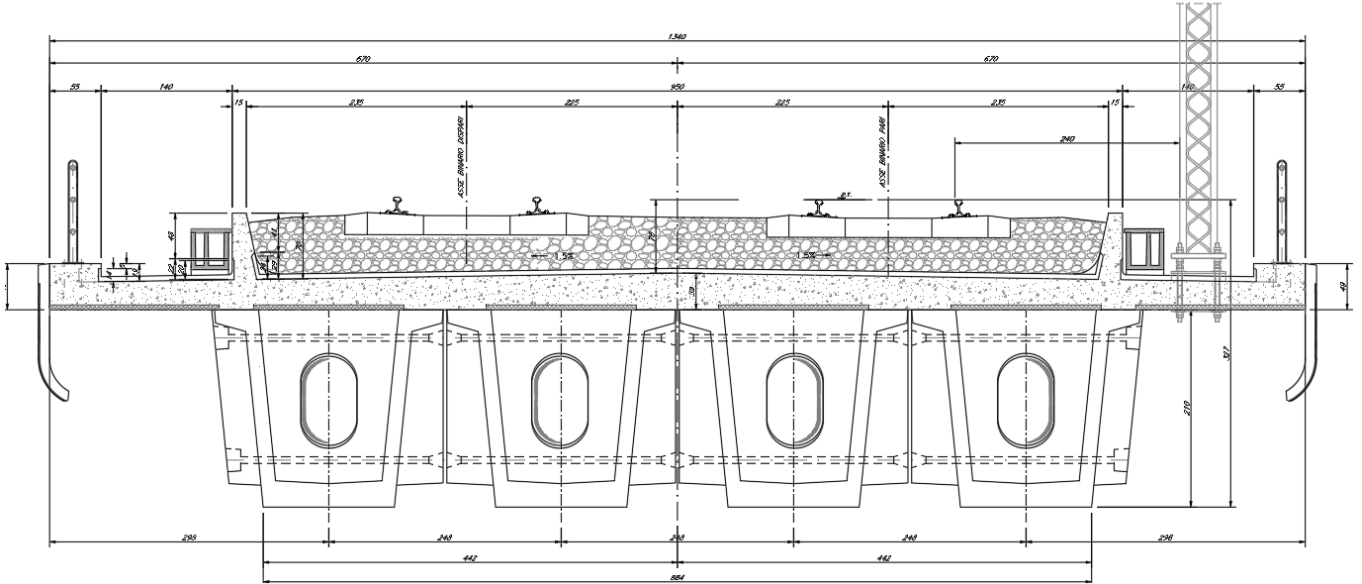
Sezione tipo viadotto c.a.p. L=25.00m
